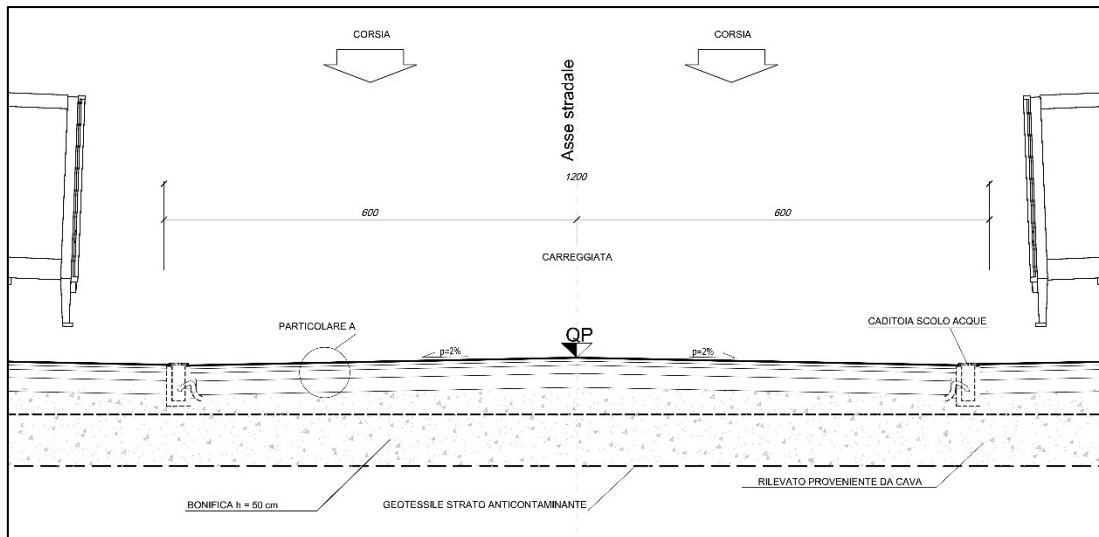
Sezione trasversale tipica asse ingresso parcheggio P2
